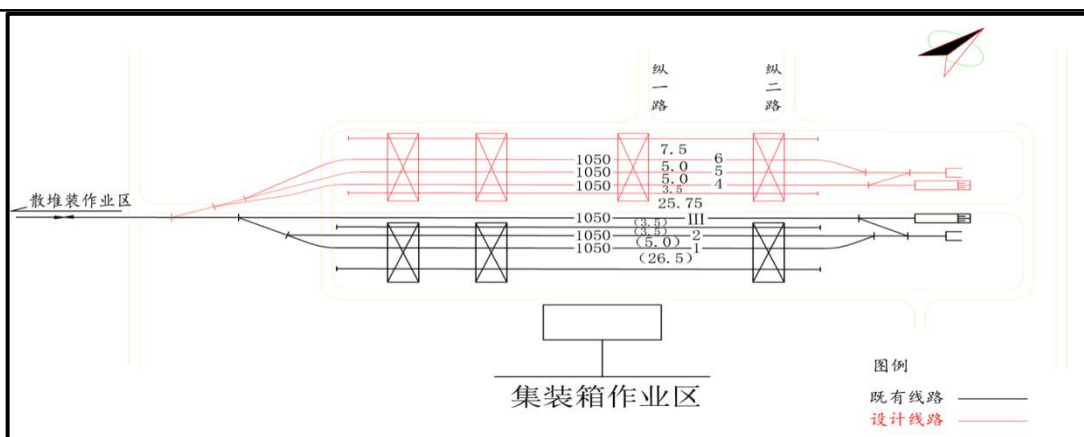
方案一 集装箱作业场北侧改扩建平面图
